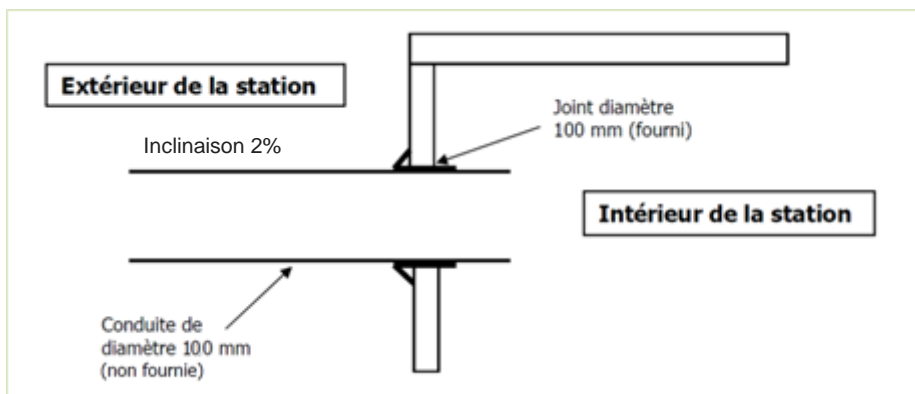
Schéma de raccordement des eaux usées à la mini station
